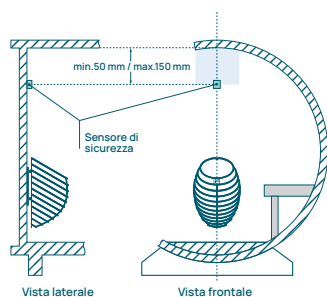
Installazione del sensore di sicurezza a parete nelle saune a botte: riscaldatore a parete
